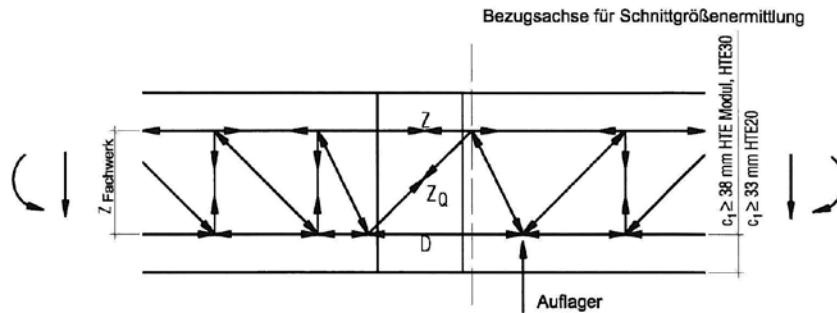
Schöck Isokorb Typ K und KF mit Betondrucklager
